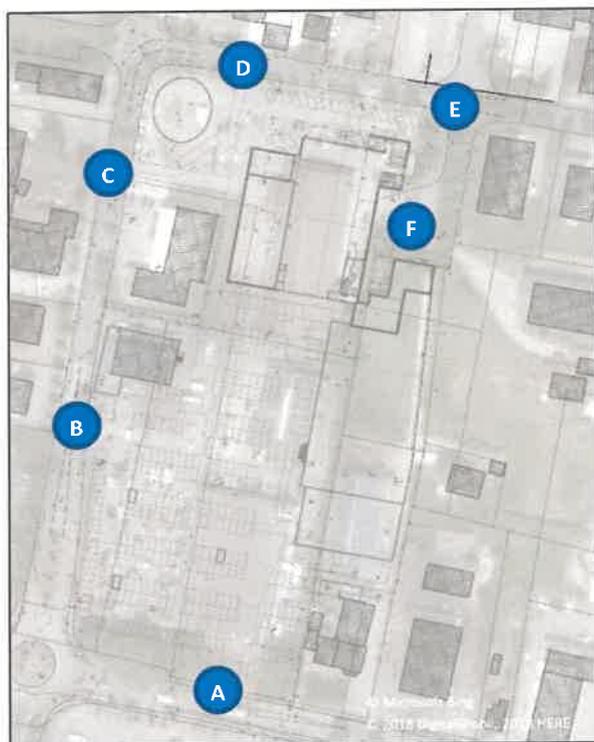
Lageplan, Luftbild überlagert mit Planungskonzept (Stand 04.07.2016)
